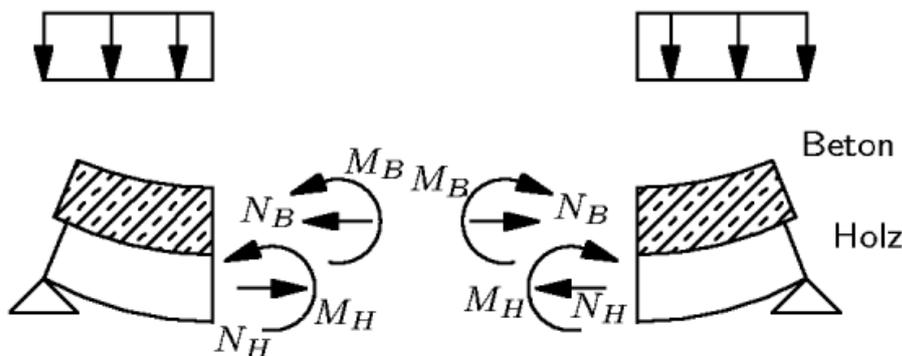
Schnittgrößen bei einem Holz-Beton-Einfeldträger<sup>226</sup>
